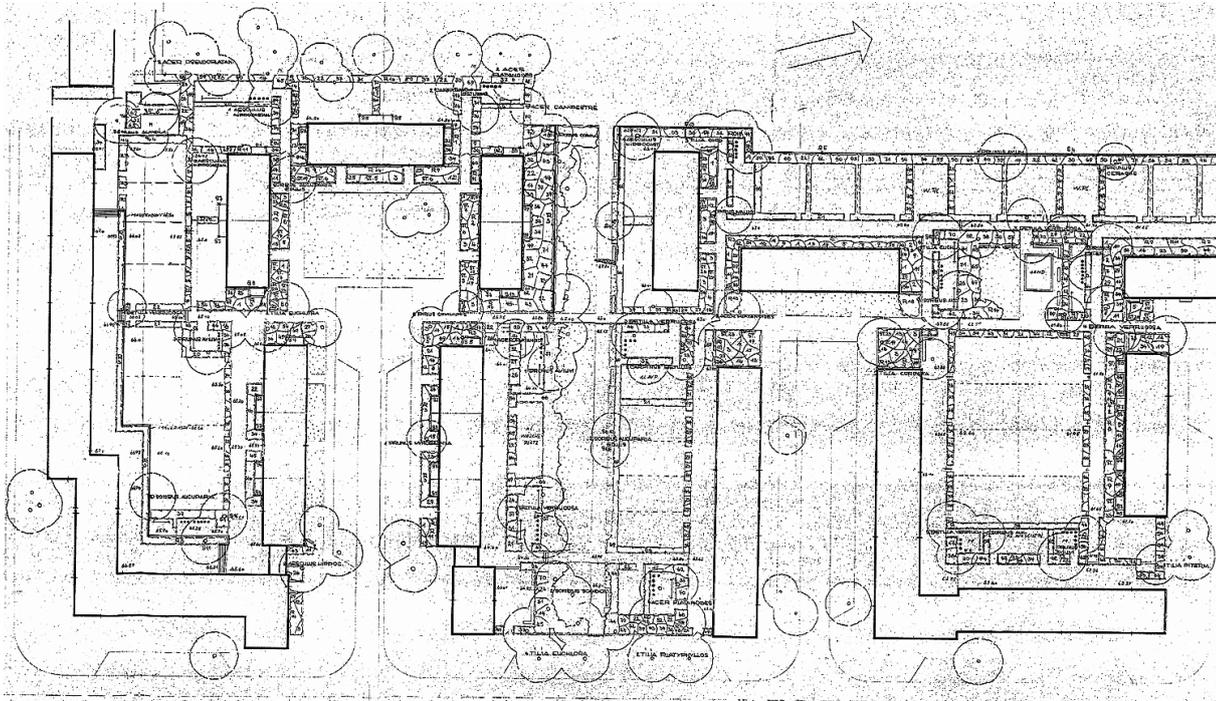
Ausschnitt Pflanzplan Scheffelhof und Halbehof von 1940
